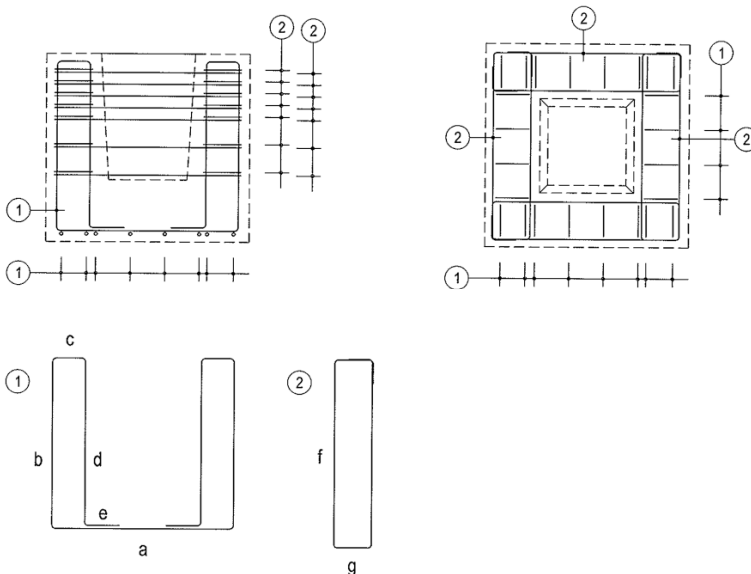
Prinzip des Köcherkorbes in den zwei Biegeformen 75 und 50
